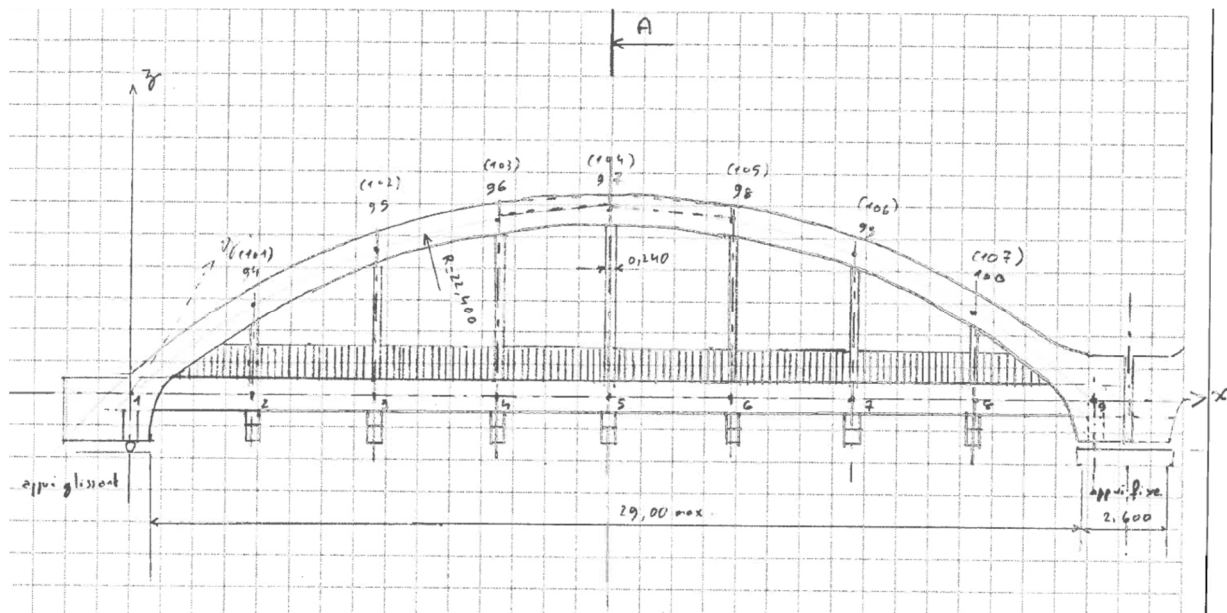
Ouvrage SNCF existant – Coupe schématique de la structure d'un bow-string (Source : INGEROP)
